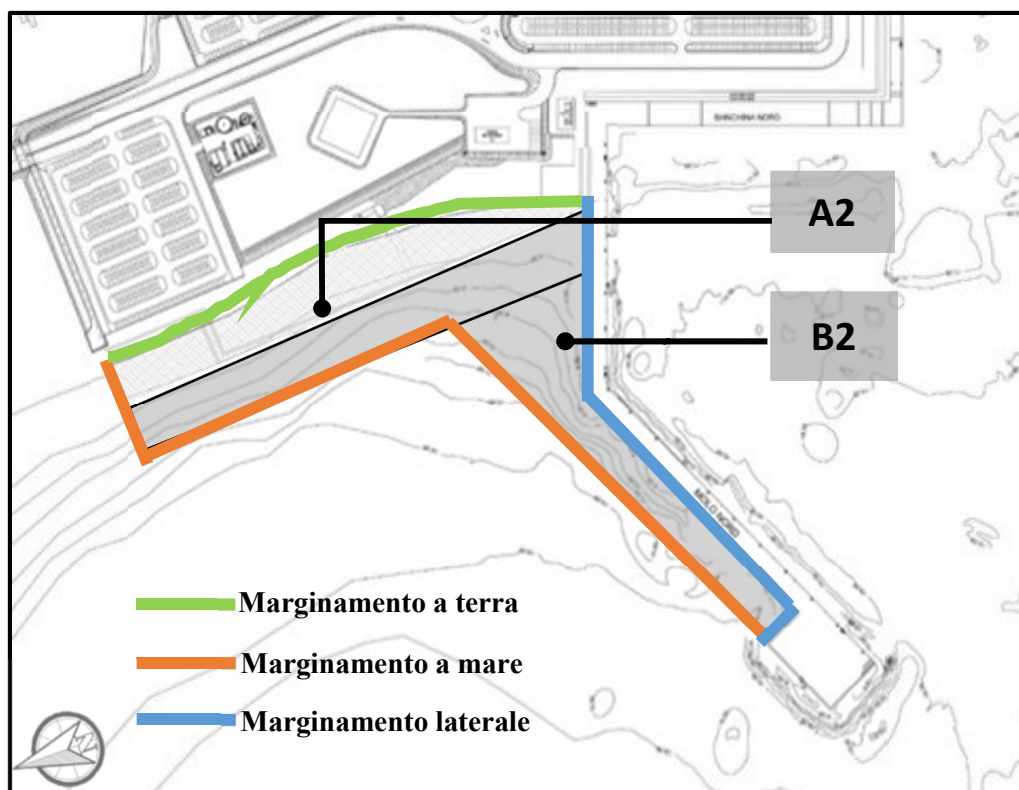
Planimetria vasca di colmata con la stabilizzazione di massa
